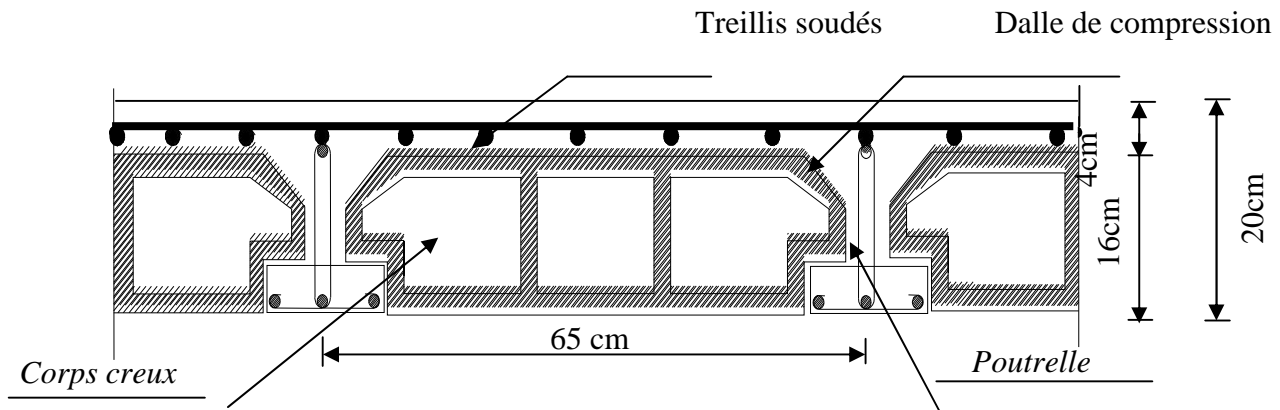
Schéma descriptif d'un plancher en corps creux.
